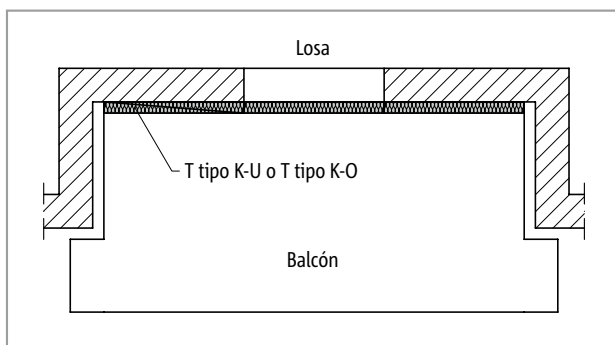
Schöck Isokorb® T tipo K-U o T tipo K-O: Balcón en fachada retranqueada
